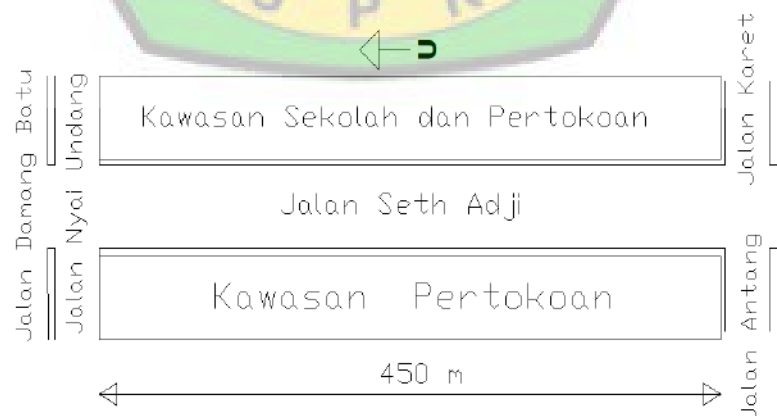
Potongan Melintang Jalan Seth Adji- Damang Batu-Nyai Undang
